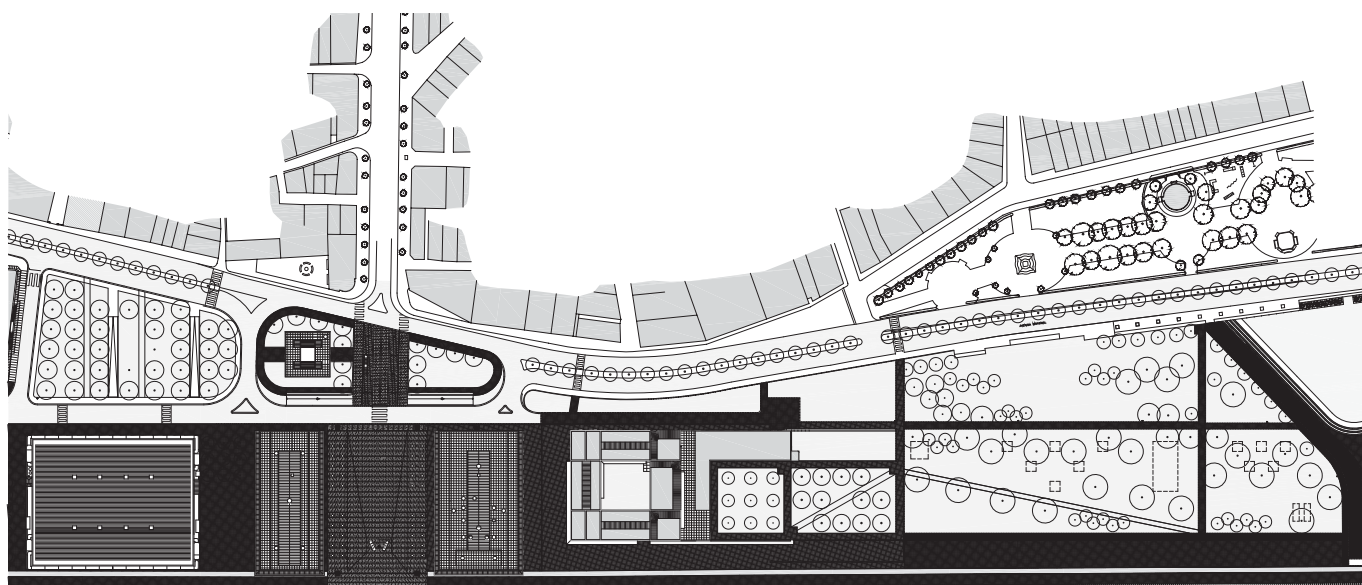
Planta de implantação da frente ribeirinha de Viana do Castelo.
